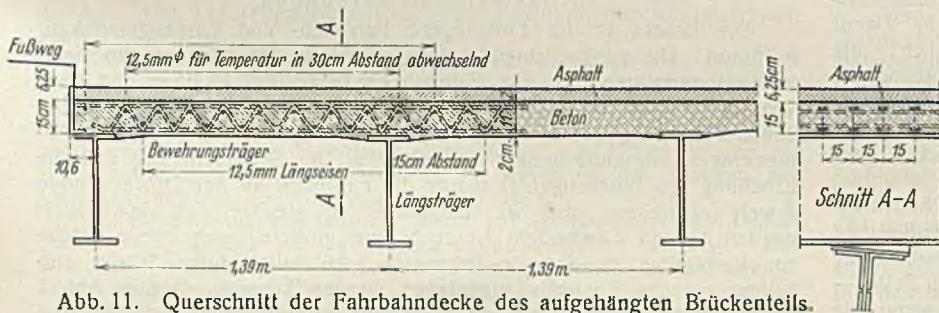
Querschnitt der Fahrbahndecke des aufgehängten Brückenteils.
